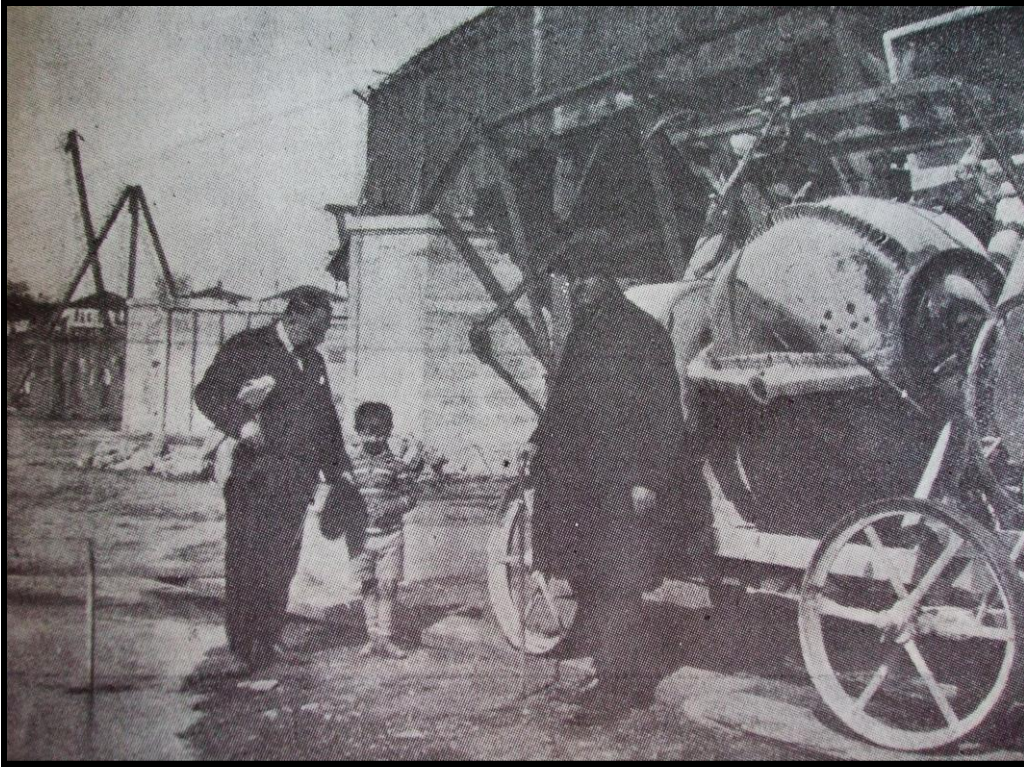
Betonarme köprünün ayakları bitmiş, kirişler atılıyor (Anonim).
